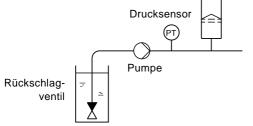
Position des Rückschlagventils und des Drucksensors in Anlagen mit Saugbetrieb
